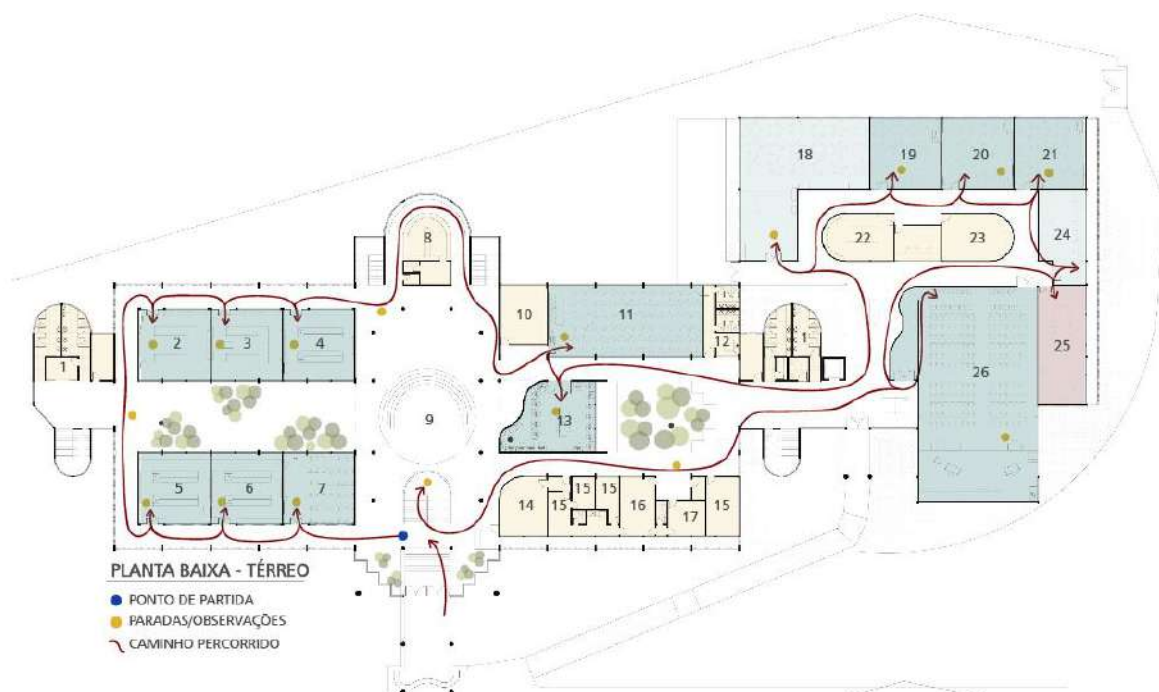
Walkthrough (caminho percorrido): primeiro pavimento -
